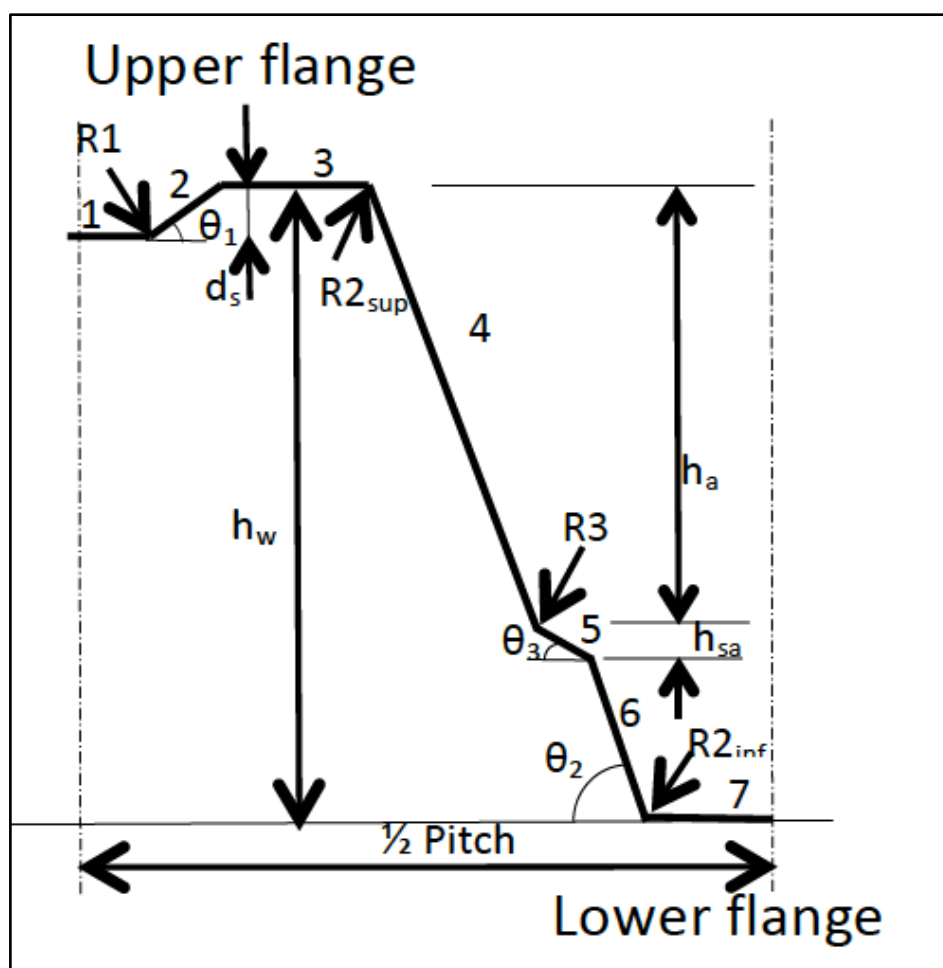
Section transversale de la plaque nervurée (1/2 nervure sans ouverture)
